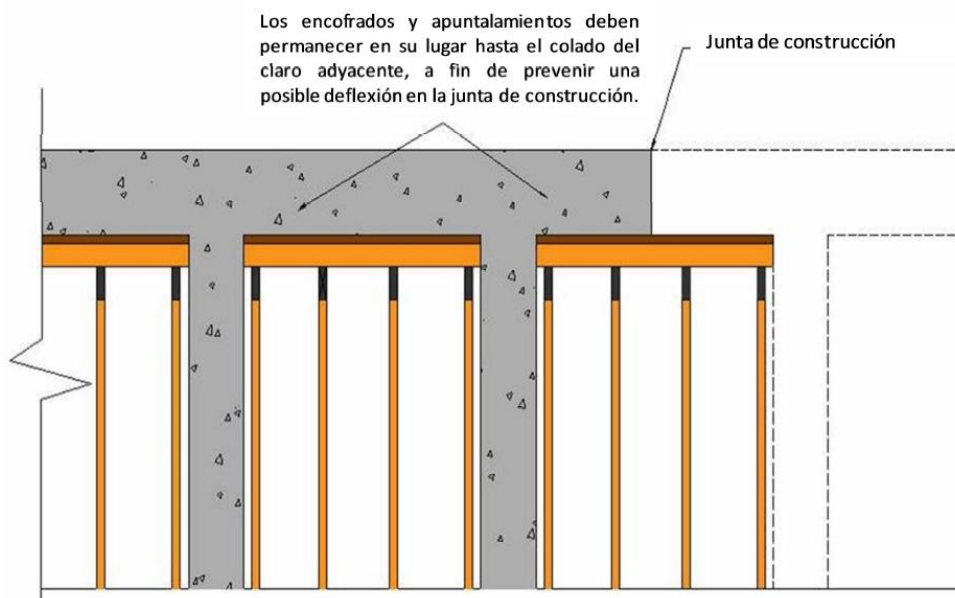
Ubicación de Juntas de Construcción y desencofrado
